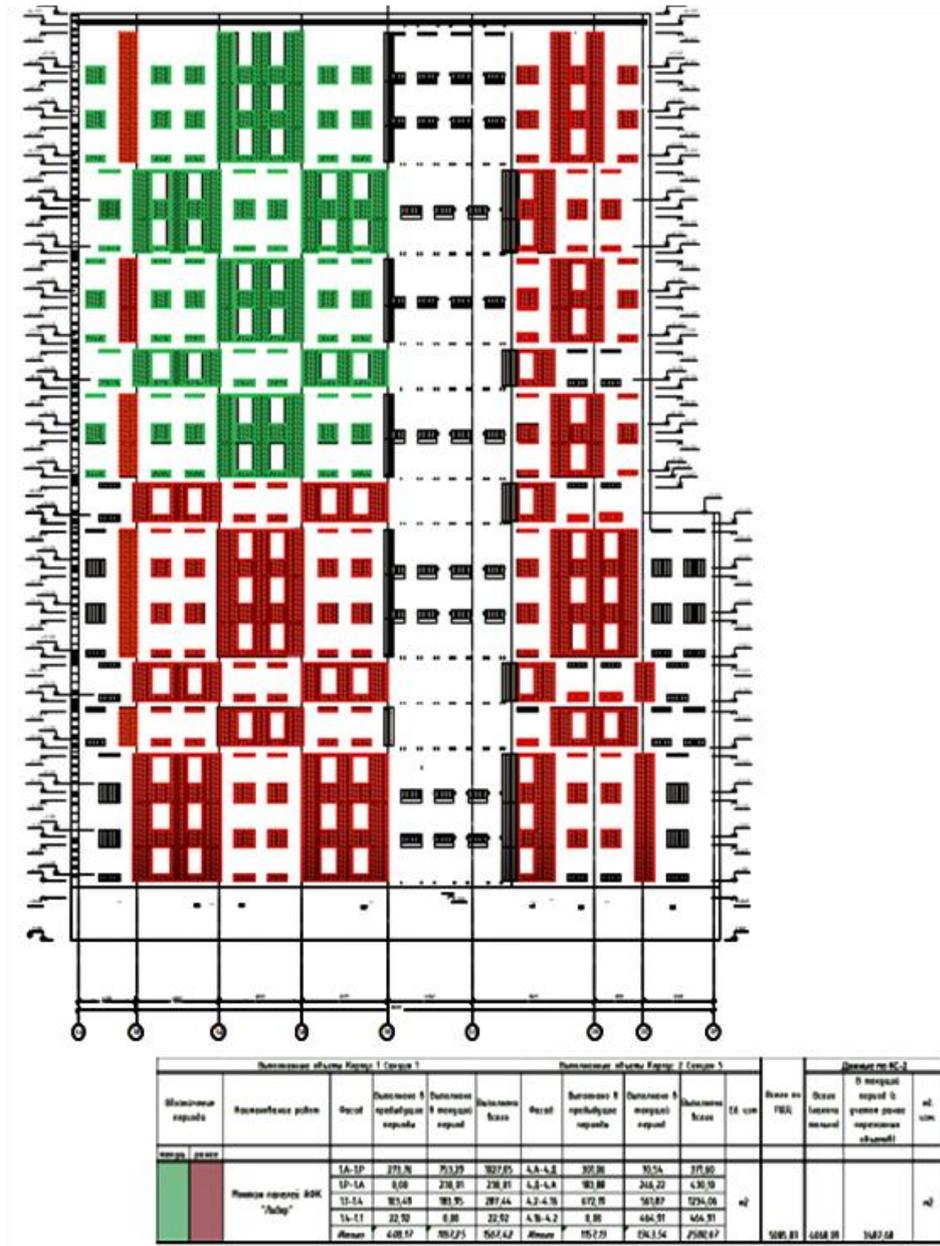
Исполнительная схема на монтаж слоя облицовки навесного вентилируемого фасада
